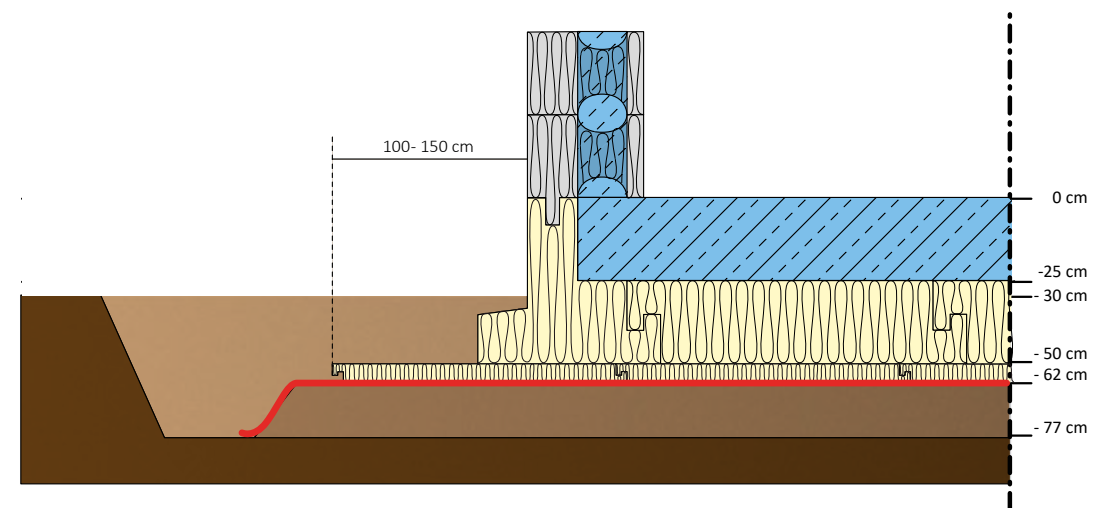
Construcție schematică a fundației cu planșeu folosind izolație termică suplimentară
